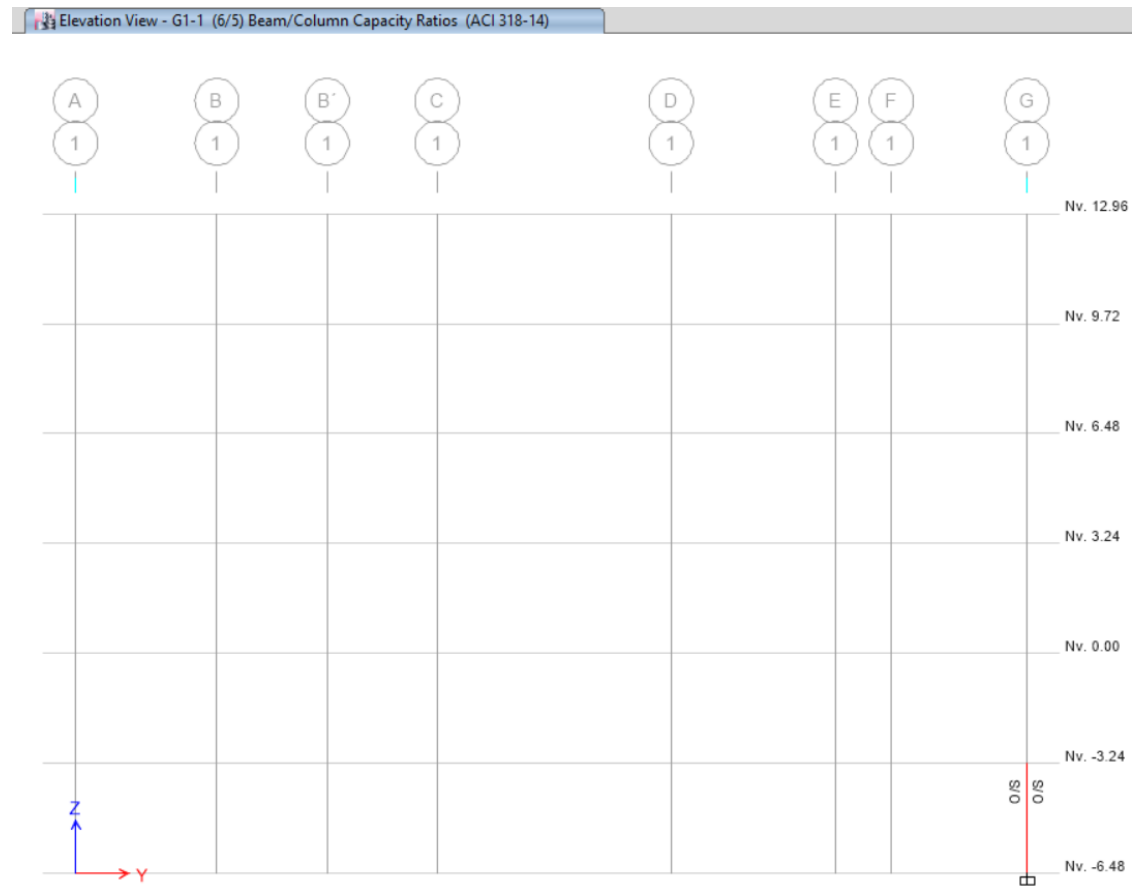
Vista en elevación de factor de capacidad unión viga-columnas, pórtico eje G.
